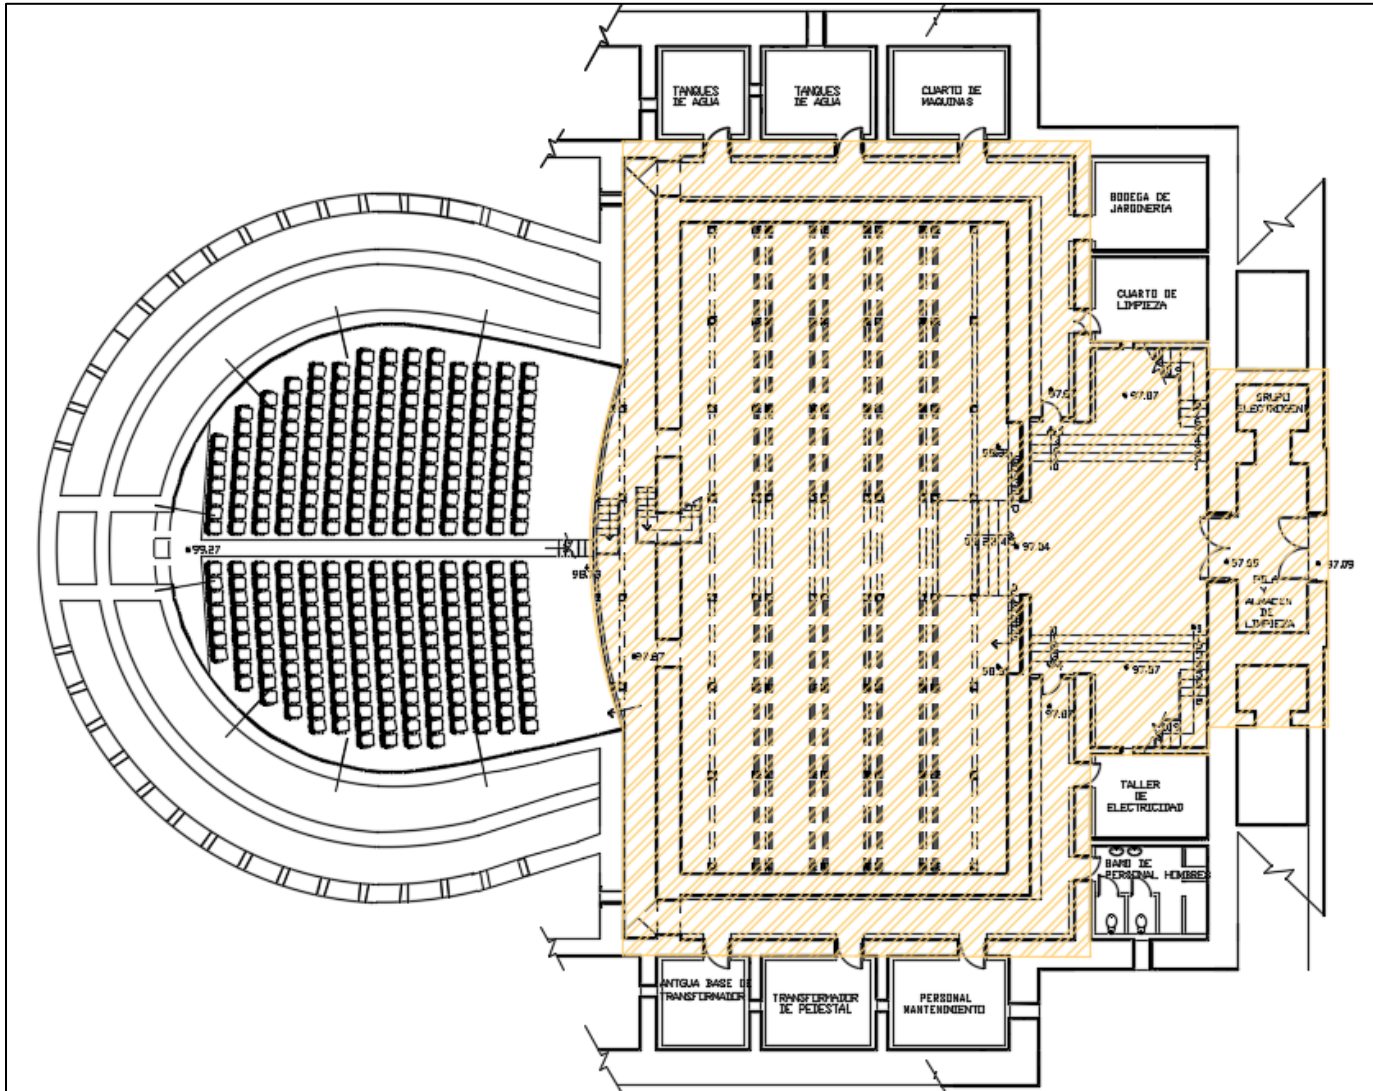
Vista en planta del Nivel 1 de Sótanos
